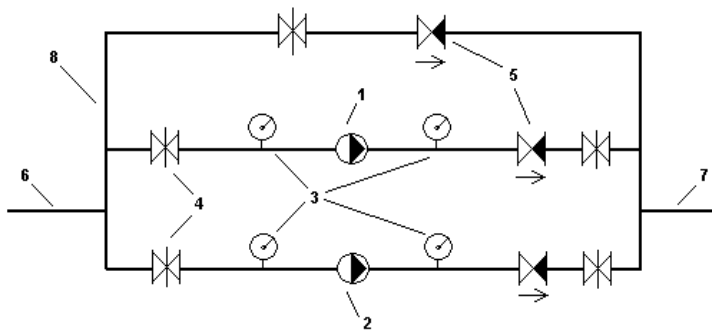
1 – рабочий насос; 2 – резервный насос; 3 – манометры; 4 – задвижки; 5 – обратный клапан.
